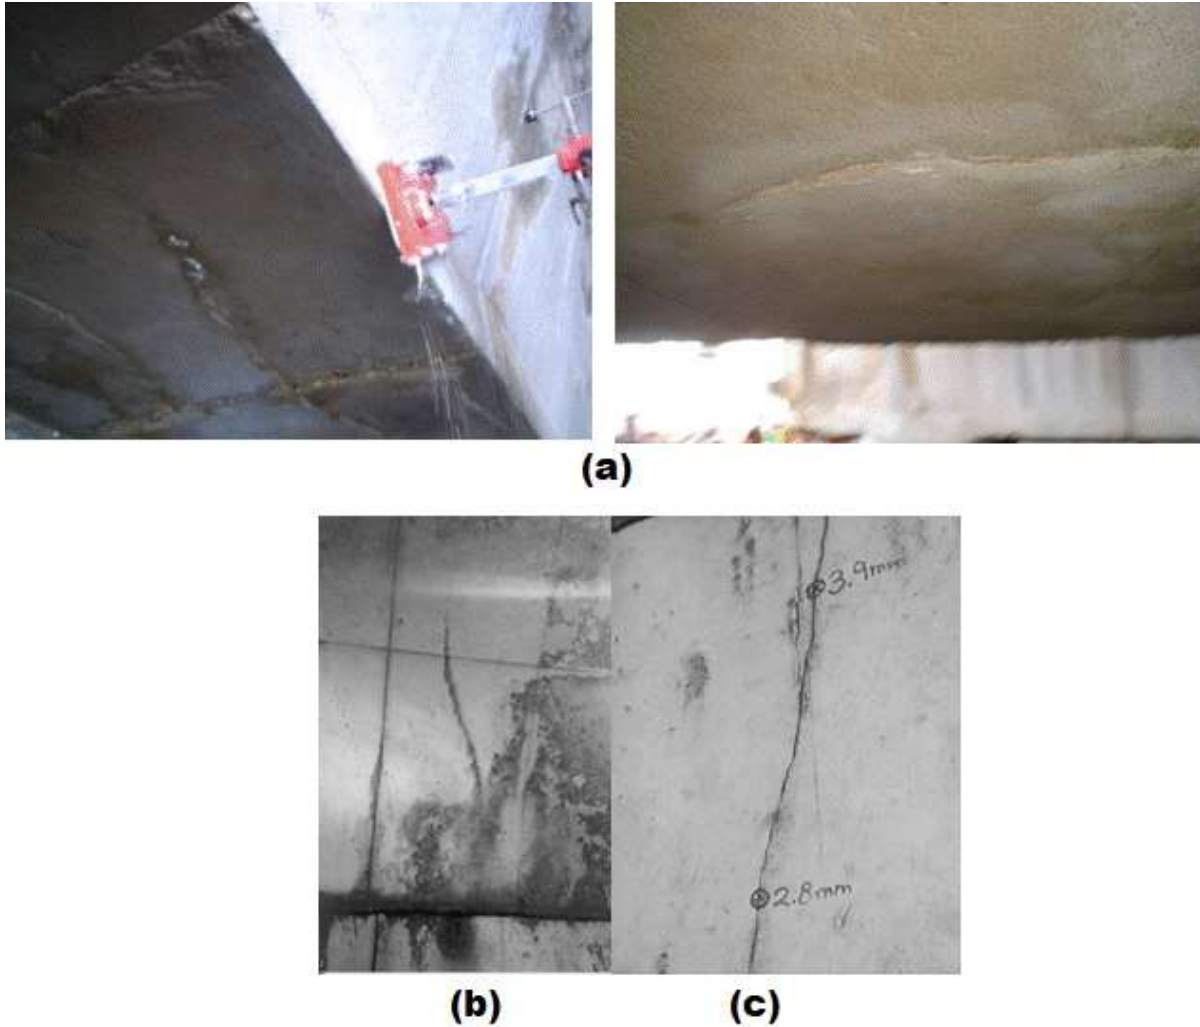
a) Evidencias de la corrosión del acero inoxidable en uno de los cabezales ubicados en la plataforma del muelle fiscal. Grietas estructurales típica observadas en b) arcos sin refuerzo estructural y c) vigas
